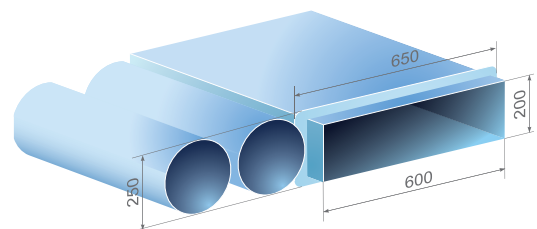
Без использования дополнительного пространства воздуховоды прямоугольного сечения часто могут заменяться несколькими воздуховодами круглого сечения.
